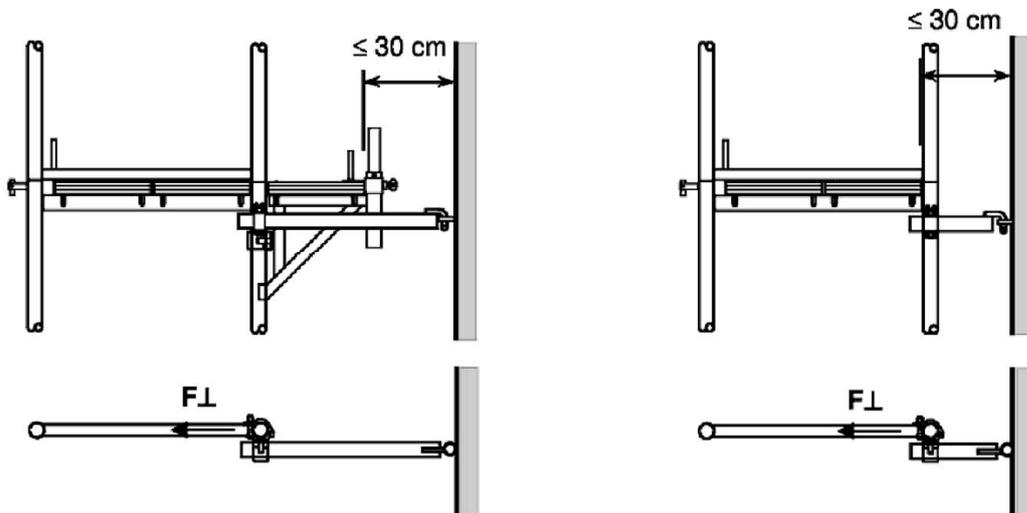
Höhenlage der Gerüsthalter bei Anschluss im „Knoten“.
